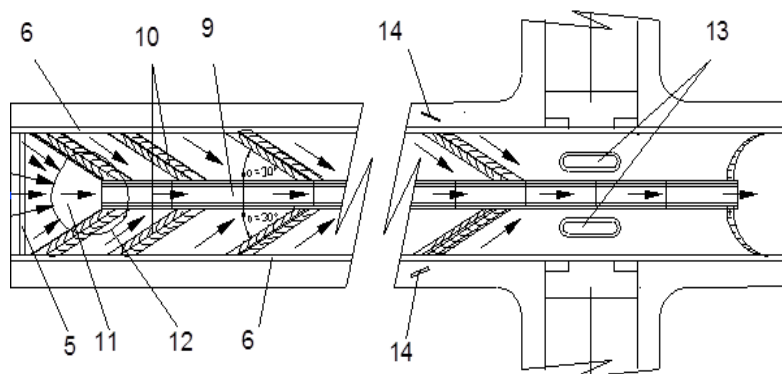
Вид сверху на участок русла реки после плотины 5, между бетонными береговыми стенками 6 по руслу реки канал с желобами 9, и валок 10 из грунтовых масс, для лежания на них льда 3 со снегом 4 без движения (рис. 5).
